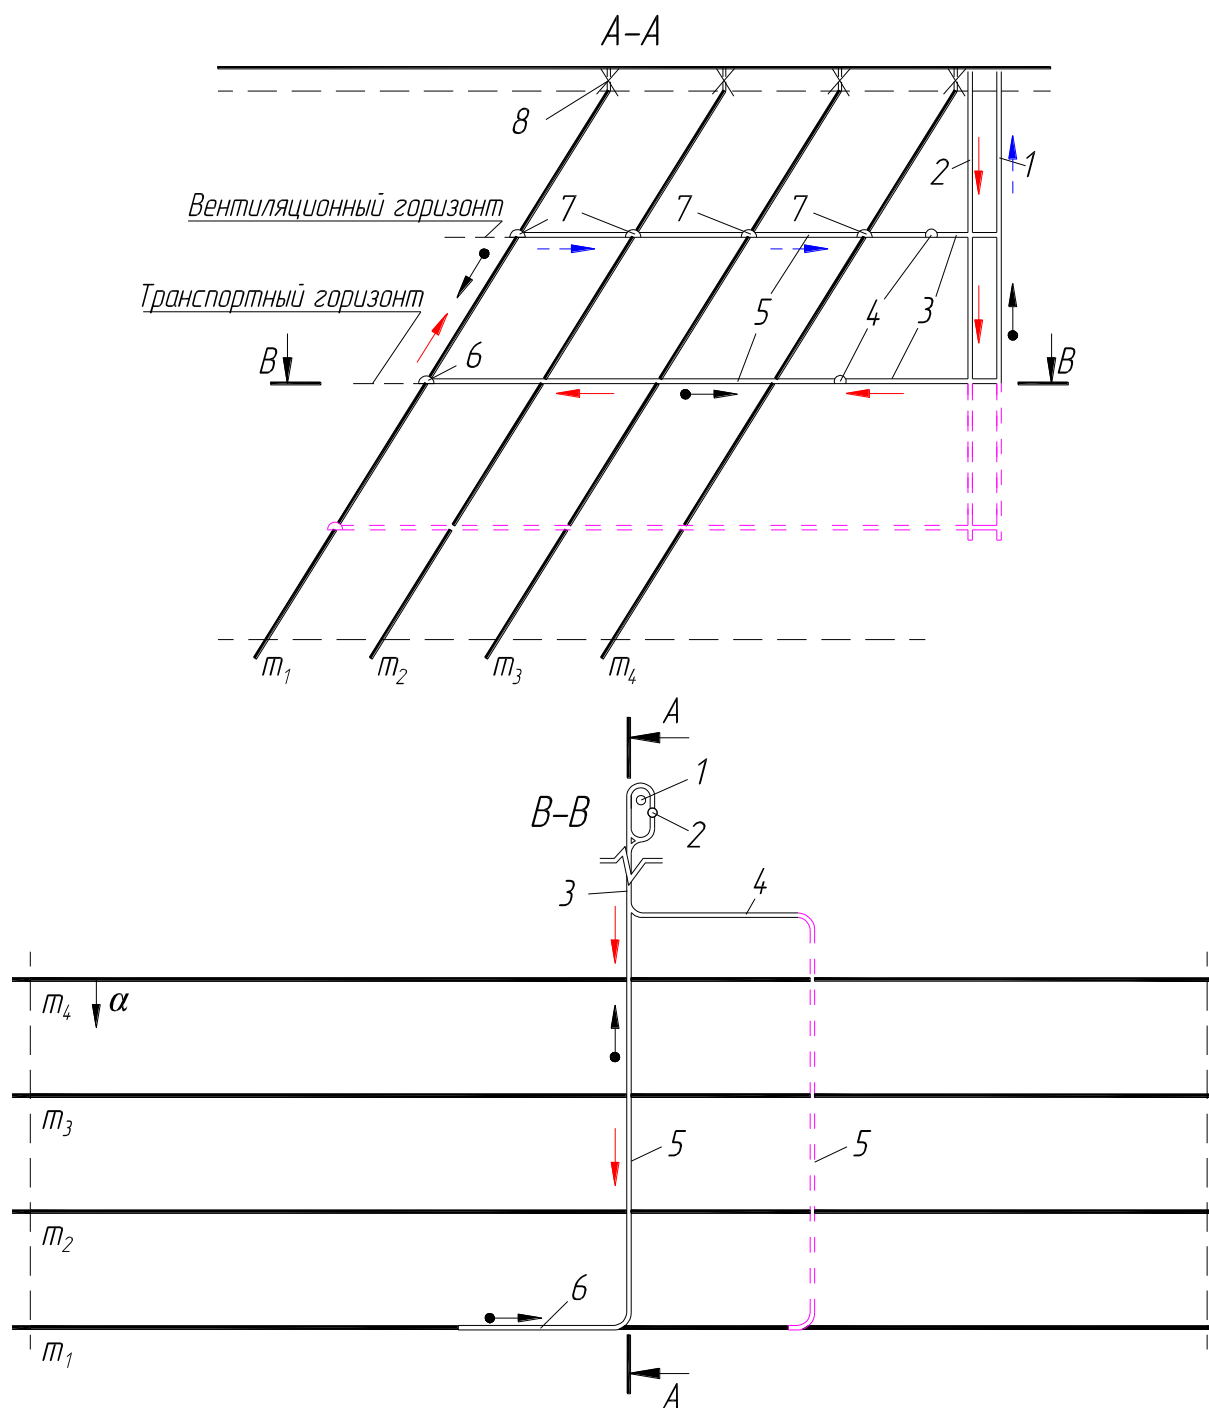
Схема вскрытия вертикальными стволами с этажными квершлагами:
